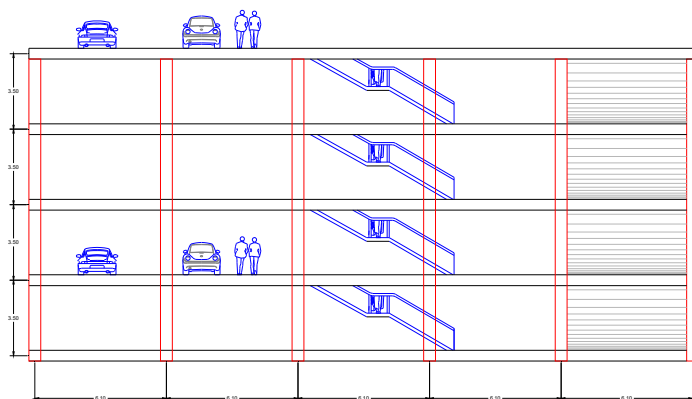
Corte De Planta Nivel 4 De Estacionamiento
